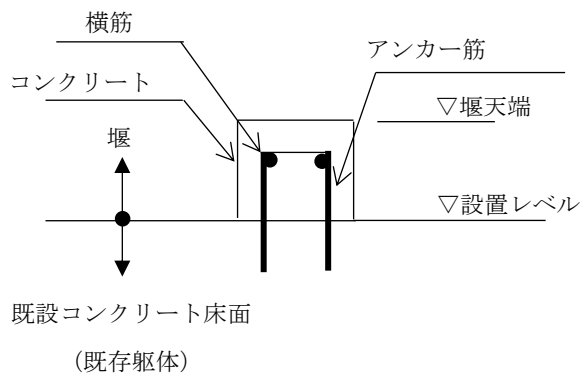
溢水伝播防止堰（鉄筋コンクリート製堰）の概略構造図
